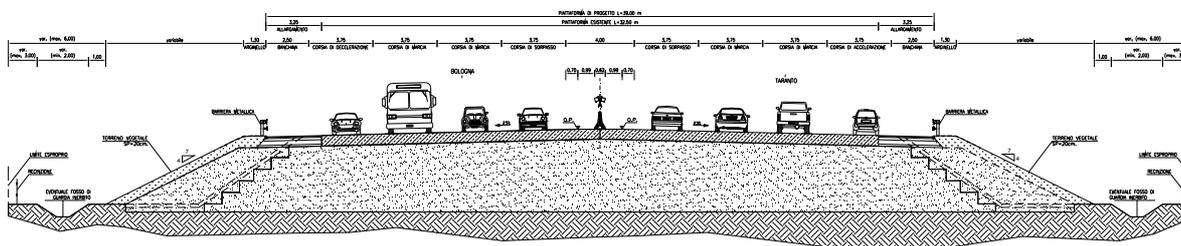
Sezione tipo di progetto in rettilo con ampliamento simmetrico (rilevato/trincea)
